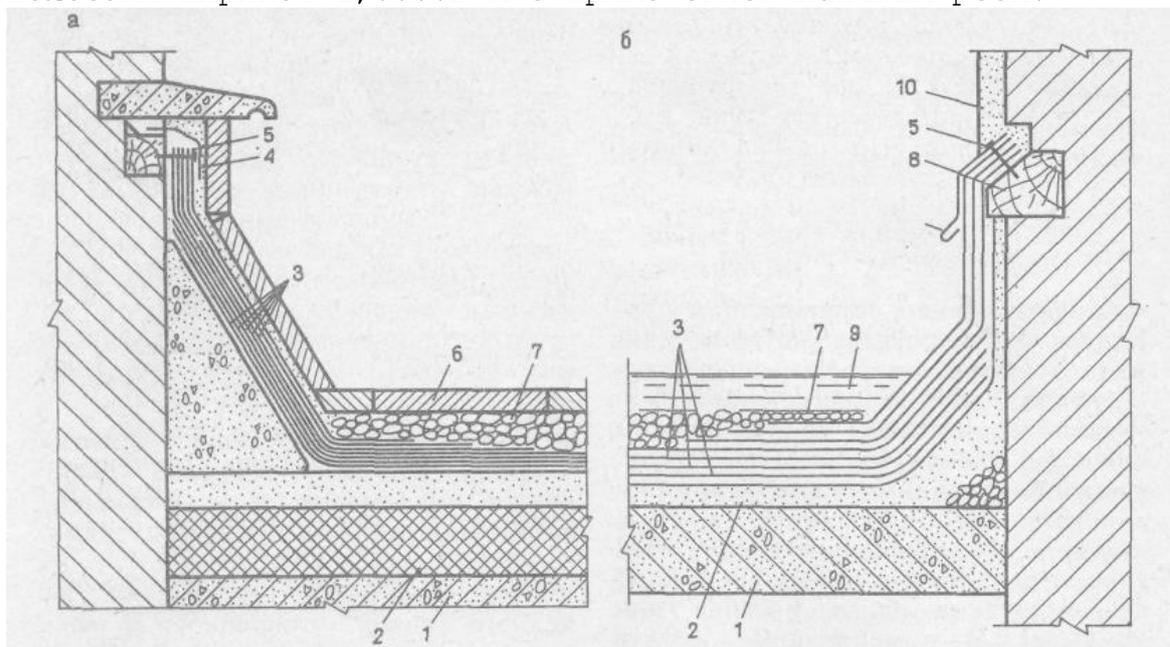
Устройство плоских эксплуатируемых (а) и водонаполненных (б) кровель : 1 - железобетонная плита; 2 - стяжка; 3 - кровельный ковер; 4 - фартук из стали; 5 - кровельный гвоздь; 6 - бетонные плиты; 7 - дренарующий слой из гравия; 8 - закладная рейка; 9 - слой воды; 10 - заделка раствором.
